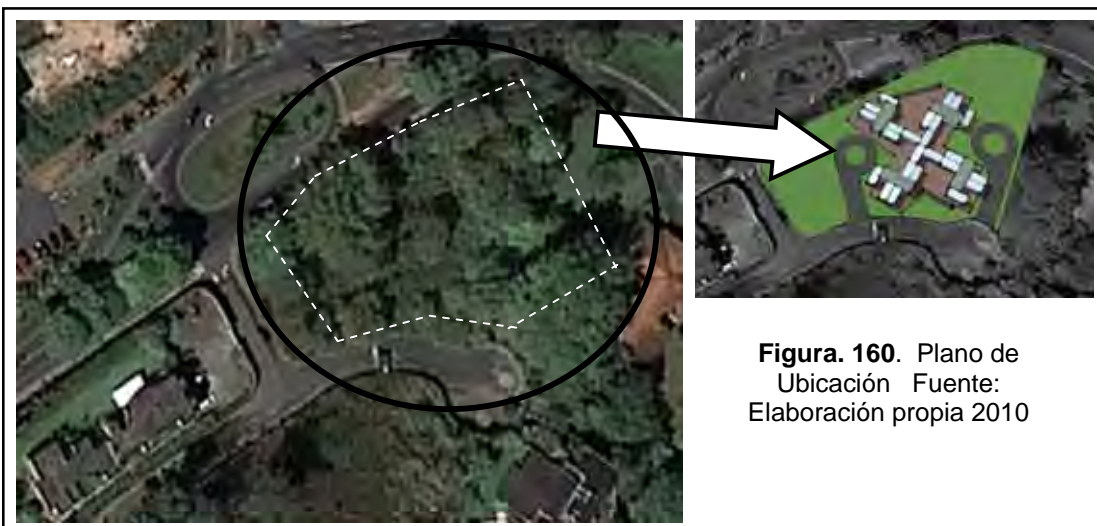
Plano de Ubicación Fuente: Elaboración propia 2010
